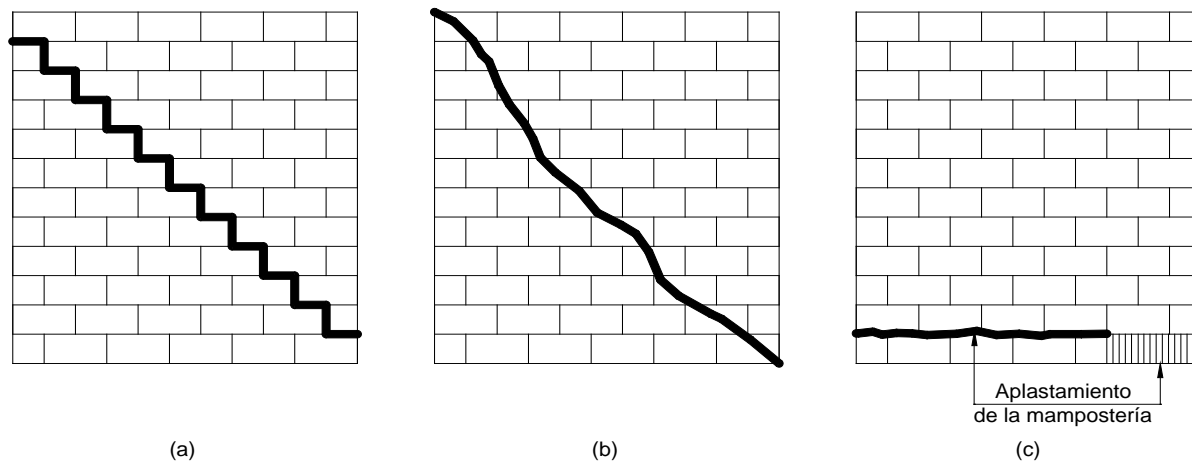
Modos de falla de la mampostería no reforzada sometida a cargas en su plano.
